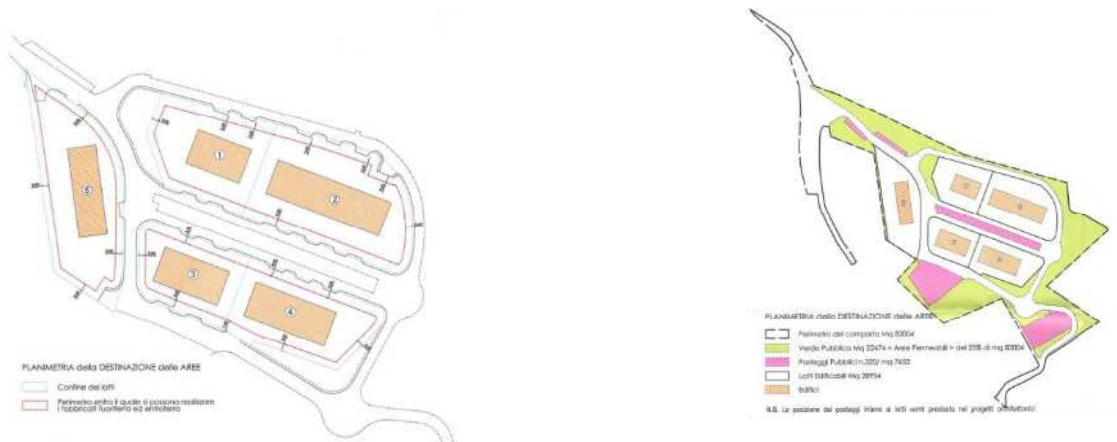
Estratto Tav. n. 16 – stato di progetto: urbanistica con destinazioni delle aree – PUC vigente
